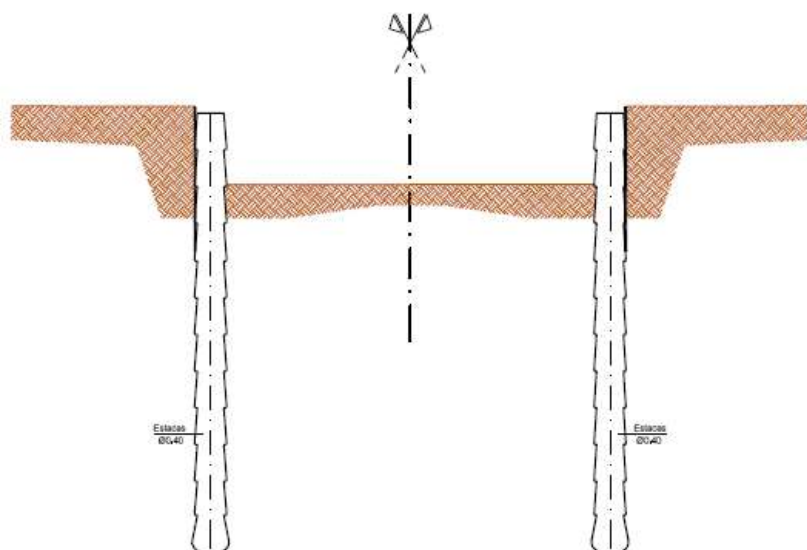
Fase 2 – Escavação das terras até ao nível da face inferior da laje superior
